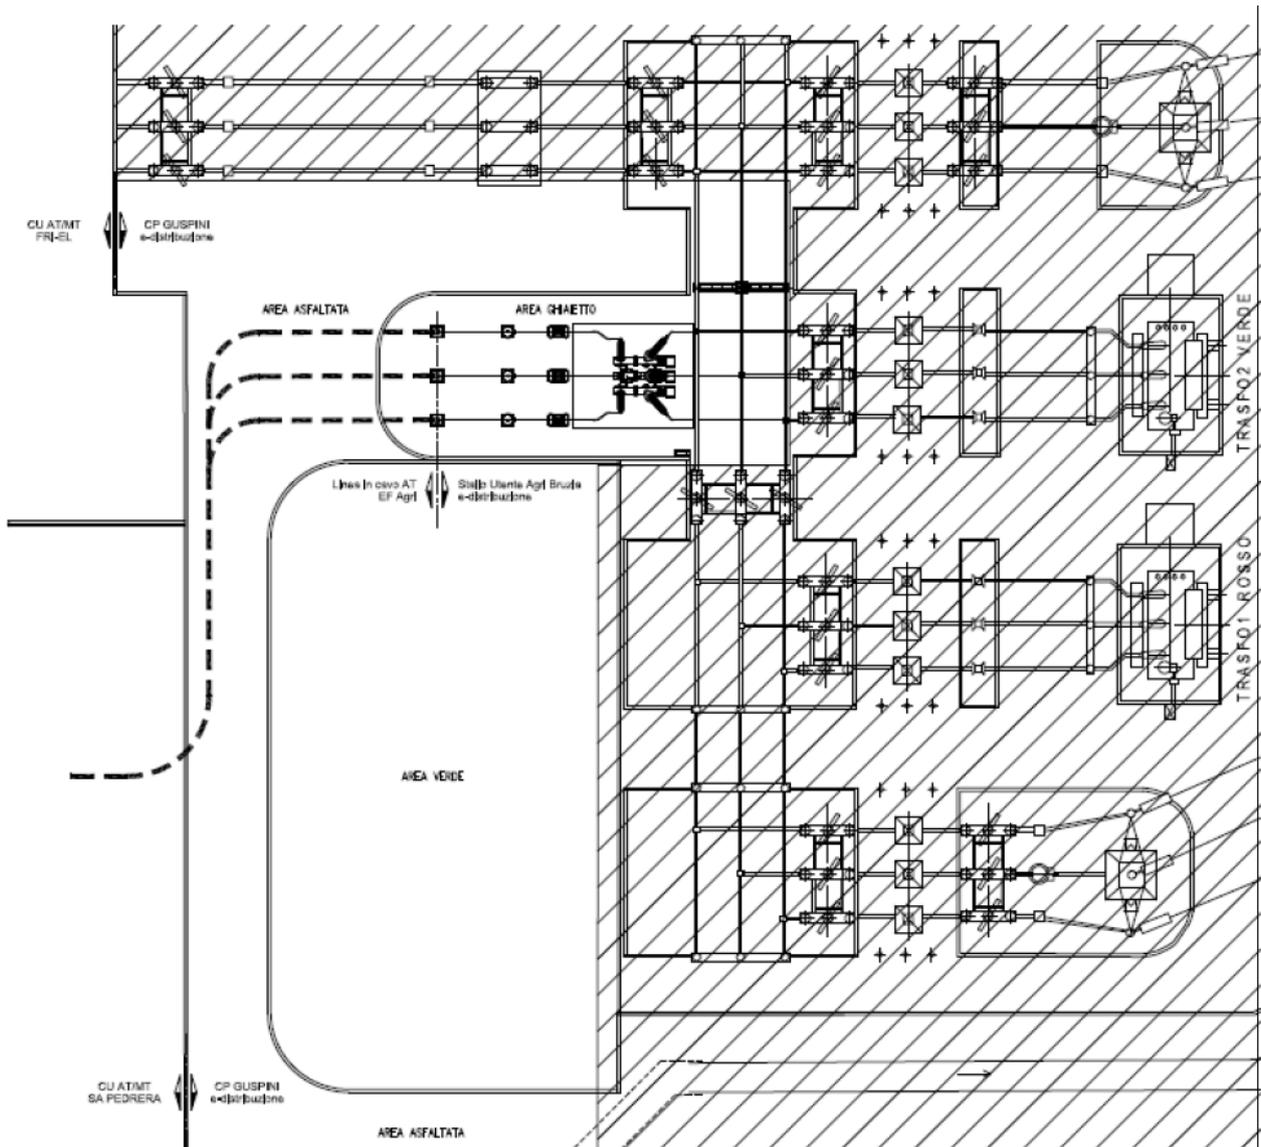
Planimetria CP con posizionamento nuovo Stallo AT
